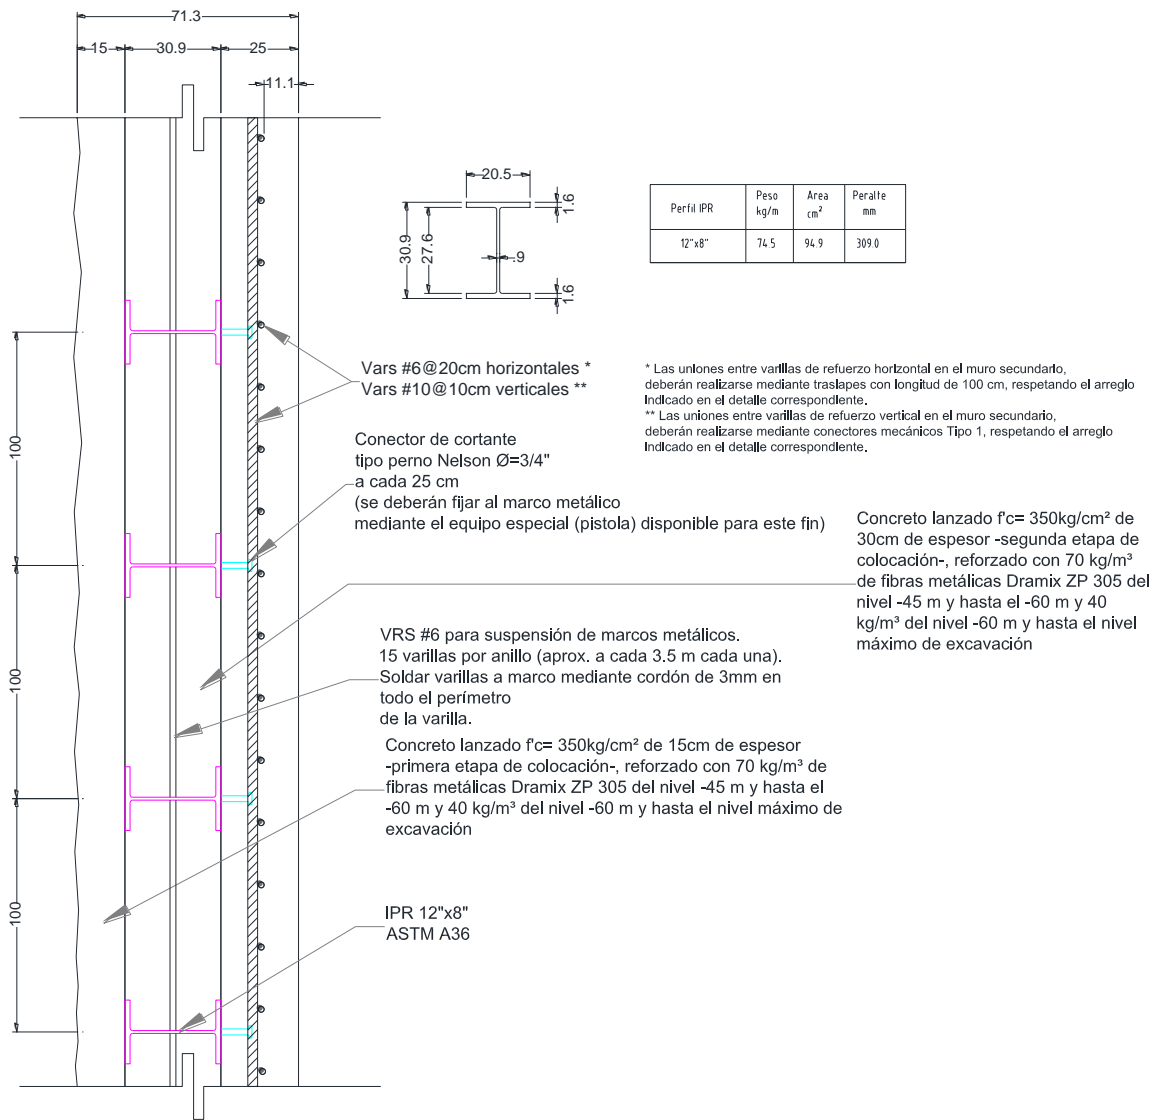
Detalle de armado de muro secundario en lumbrera L10.
